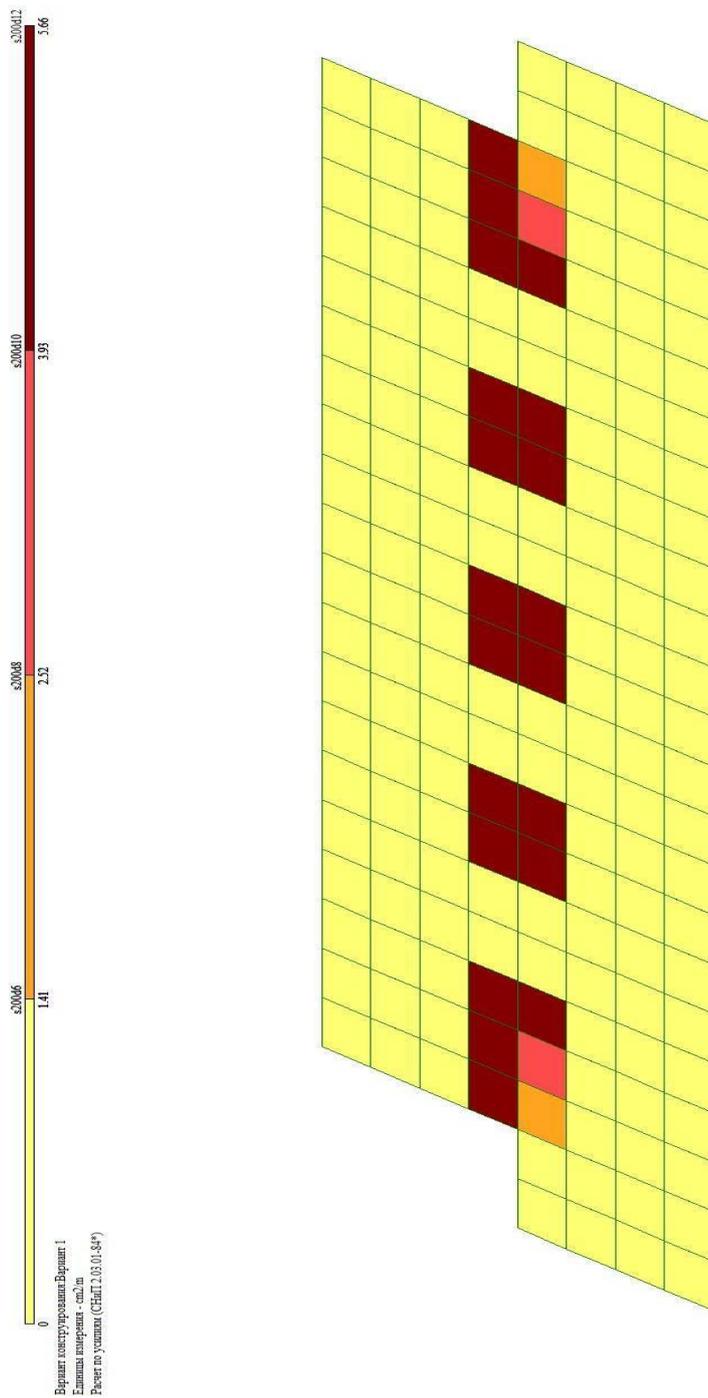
Площадь арматуры на 1 погонный метр по оси Y у нижней грани
